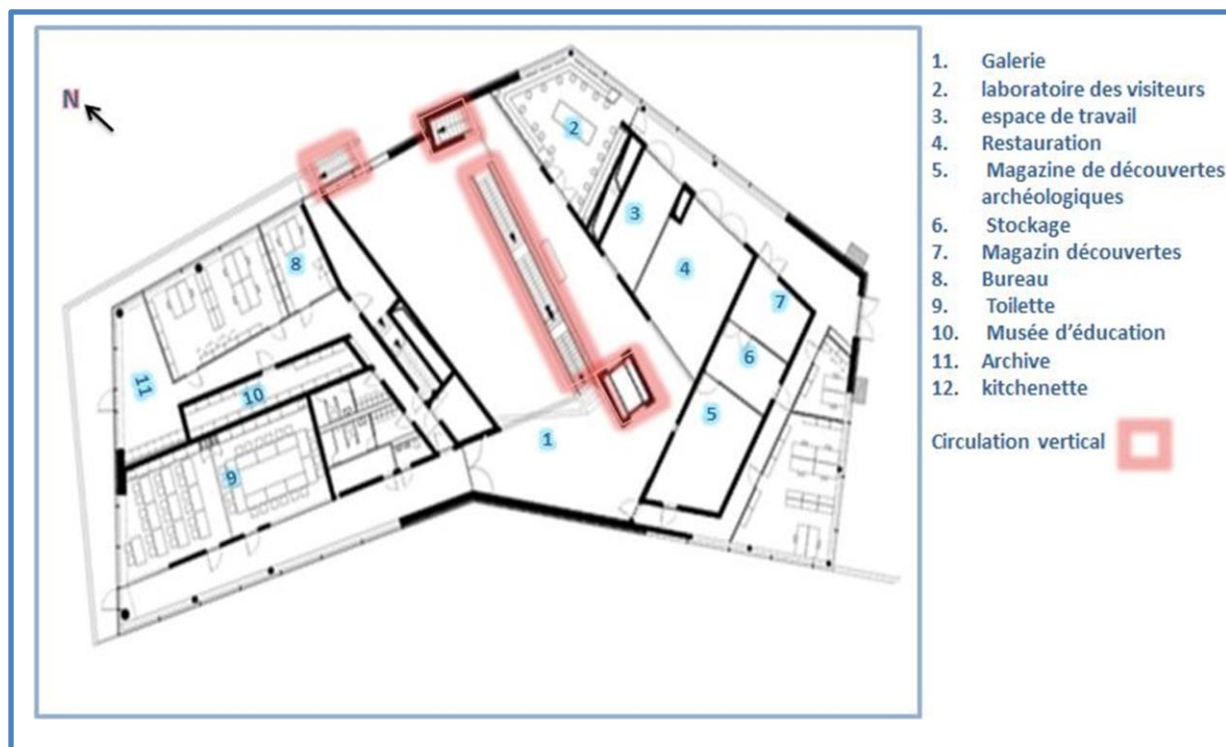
PLAN R+1 DU CENTRE .SOURCE ARCHDAILY
